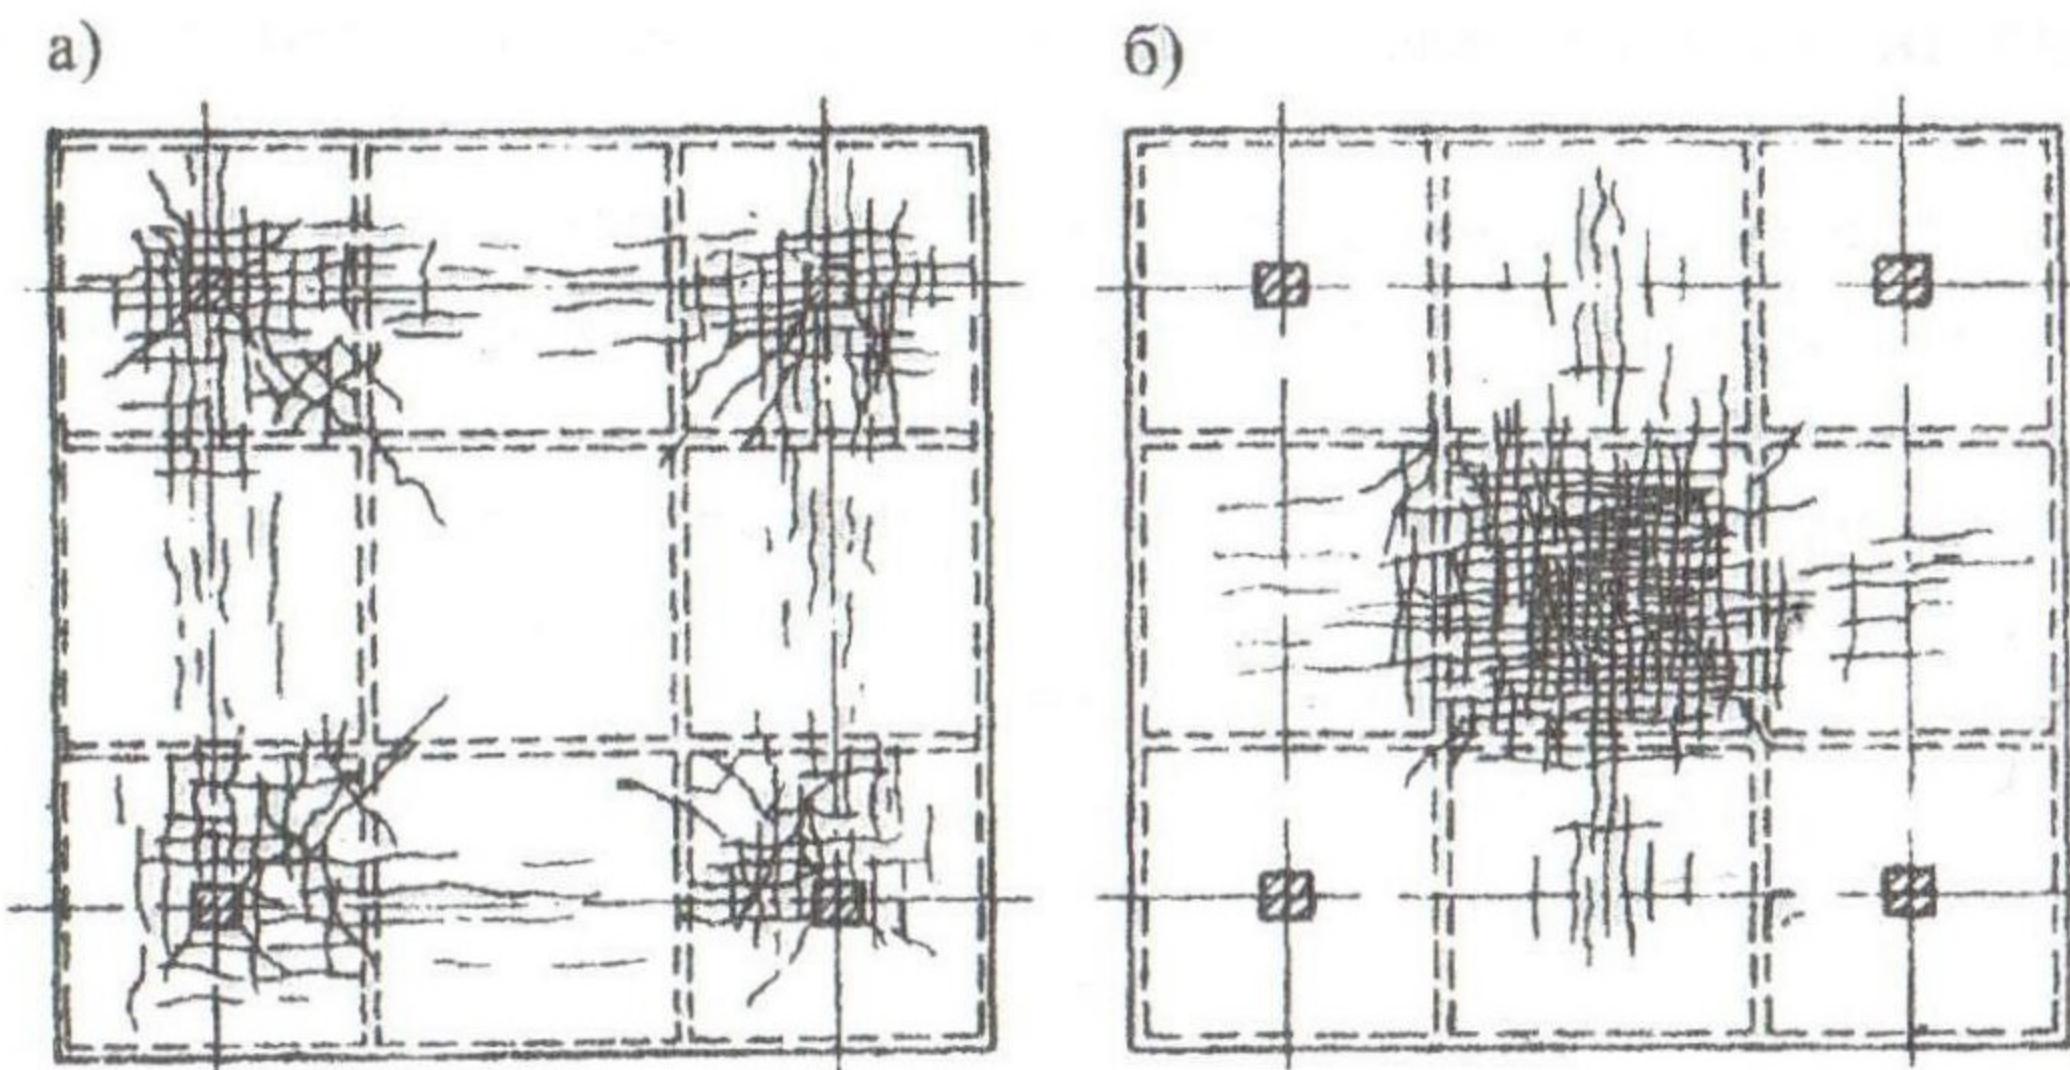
Схема трещин в плите перекрытия фрагмента
